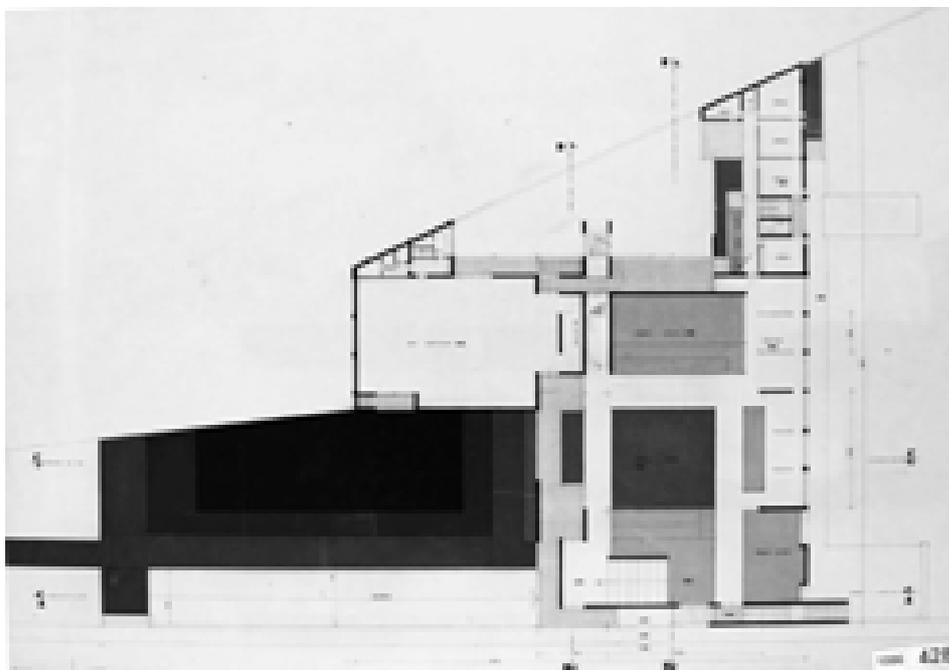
Pianta +5.60 – 15/01/1977 (AABS-1996.428)
